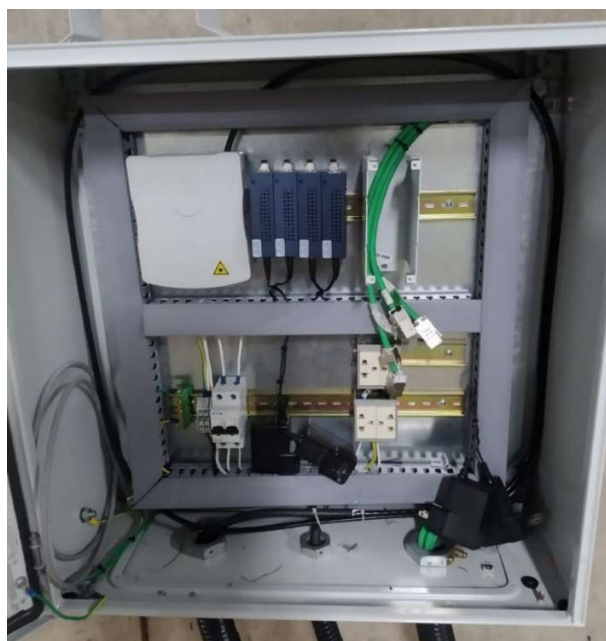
Detalle de CFAP - Caja de Fijación de Access Point
